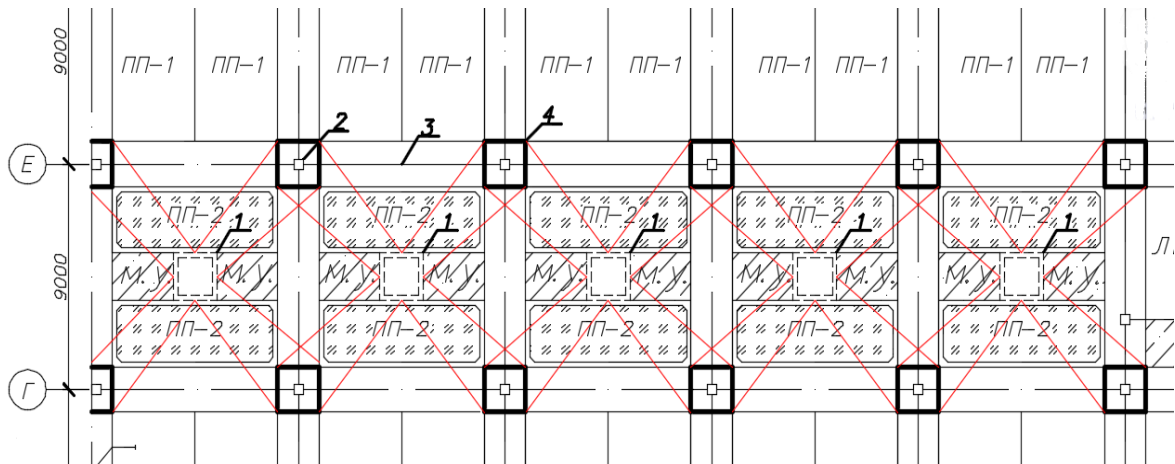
Фрагмент плана безбалочного перекрытия с расположением световых колодцев и стекложелезобетонных плит перекрытия в сборном железобетонном промышленном здании: 1– светопроемы, ПП-2 – стекложелезобетонные плиты перекрытия, М.У. – монолитный участок, 2 – колонна каркаса, 3 – надколонная плита, 4 – капитель, 5 - ПП-1 – плиты перекрытия
